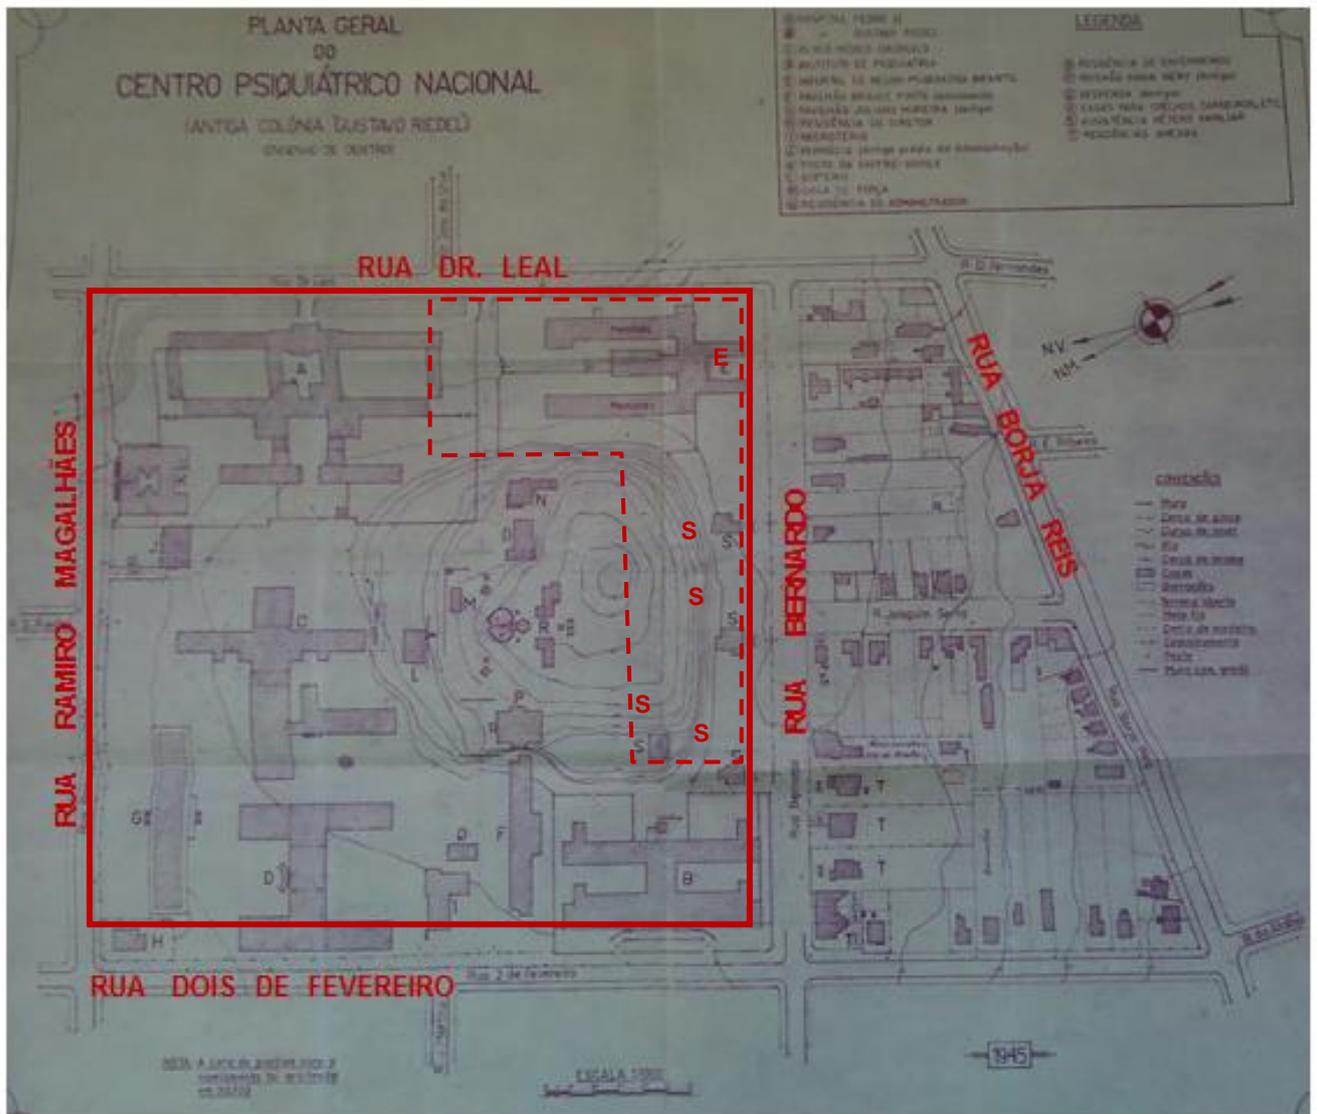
Planta do Centro Psiquiátrico Nacional, 1945.
